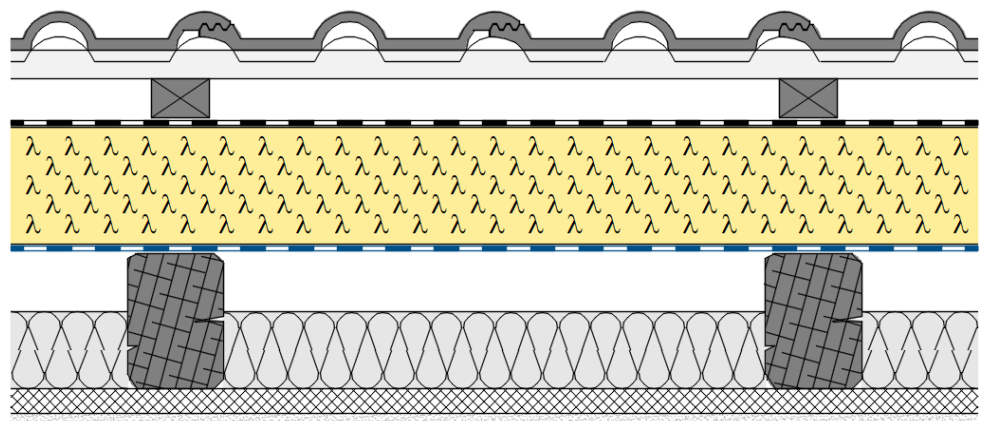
Sanierung mit vorhandener Dämmung, mit U-Wert höchstens 0,14 W/(m²·K):
